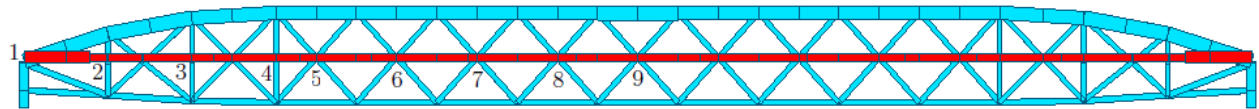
Méga-poutre. En rouge : la poutre de roulement.
